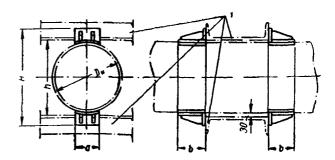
Опоры неподвижные, тип III, для  $D_{\rm H} = 273 \div 1020~{\rm мм}$  I — несущая конструкция
